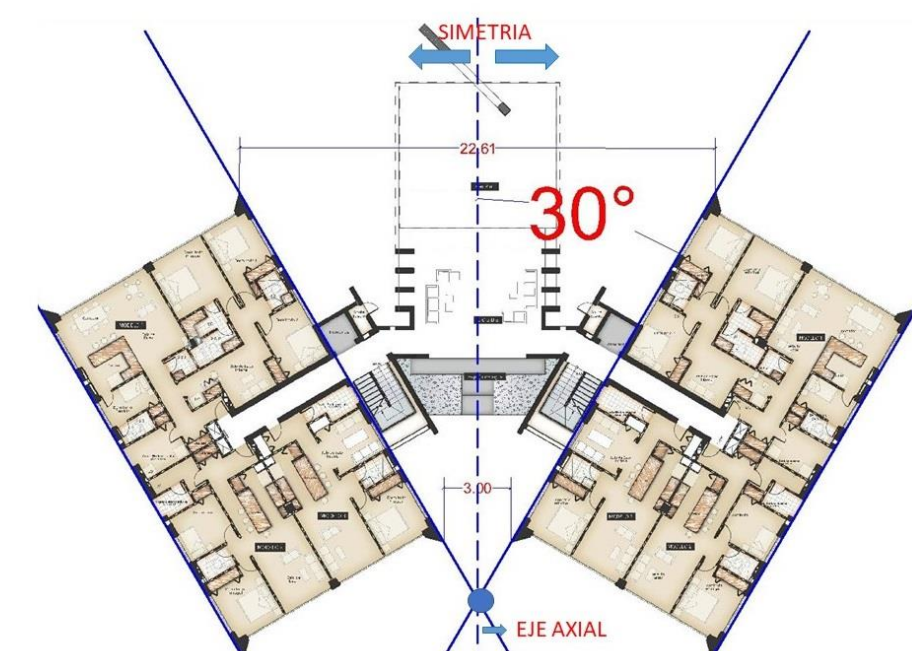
Simetría en conjunto del edificio. Fuente. Real estancia
